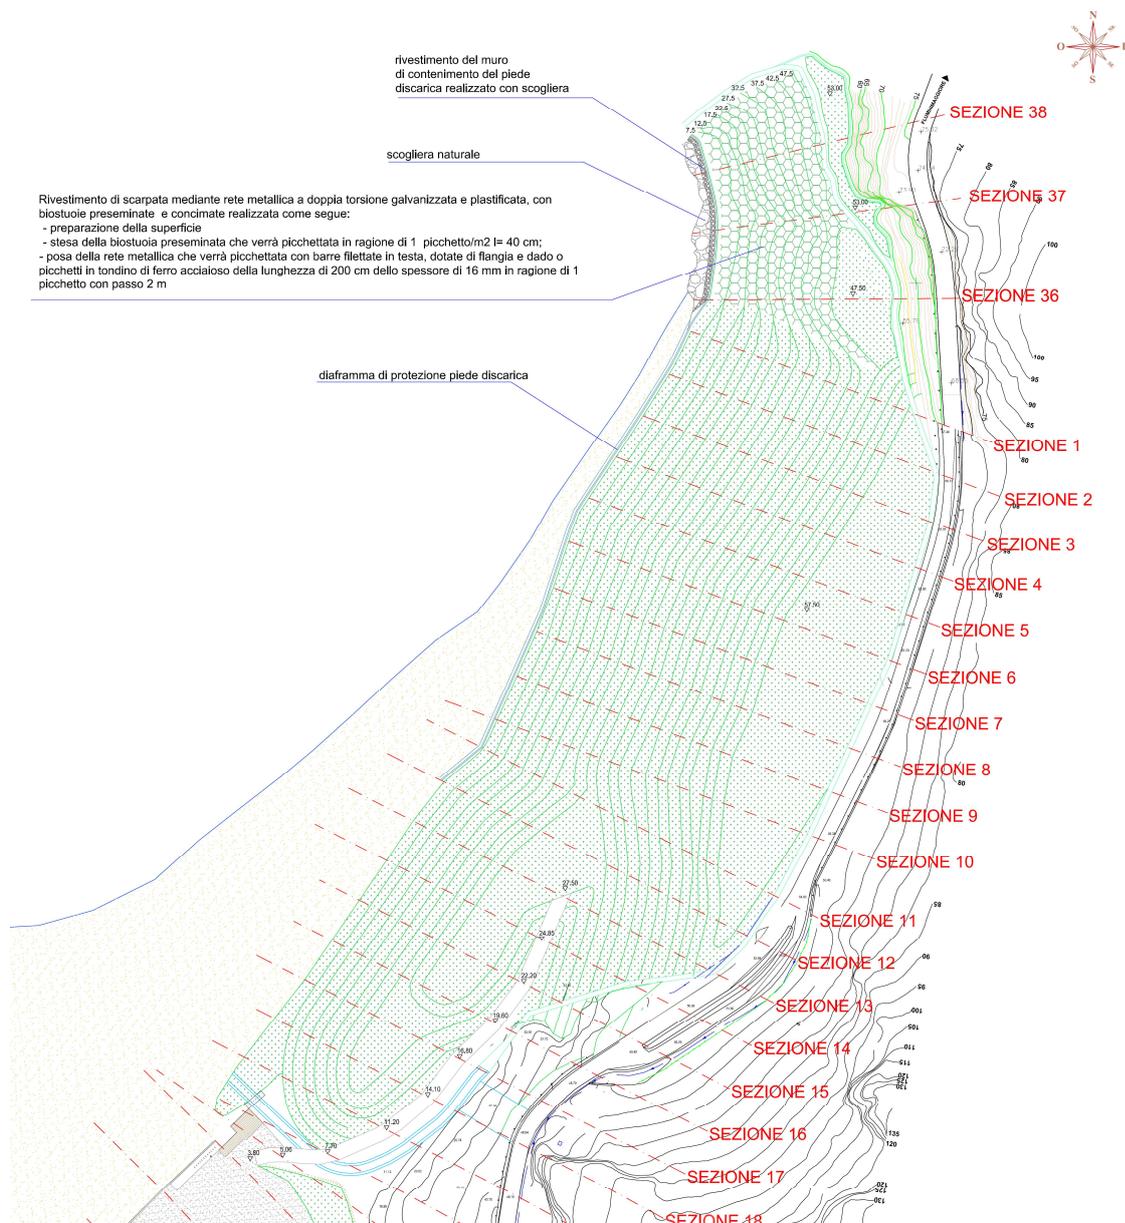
Planimetria dell'area della discarica con l'indicazione degli interventi in progetto
